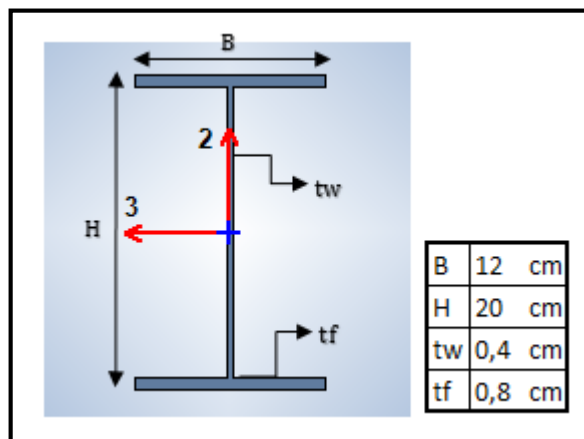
Dimensiones de Viga secundaria 2 con pórticos resistentes a momento.
